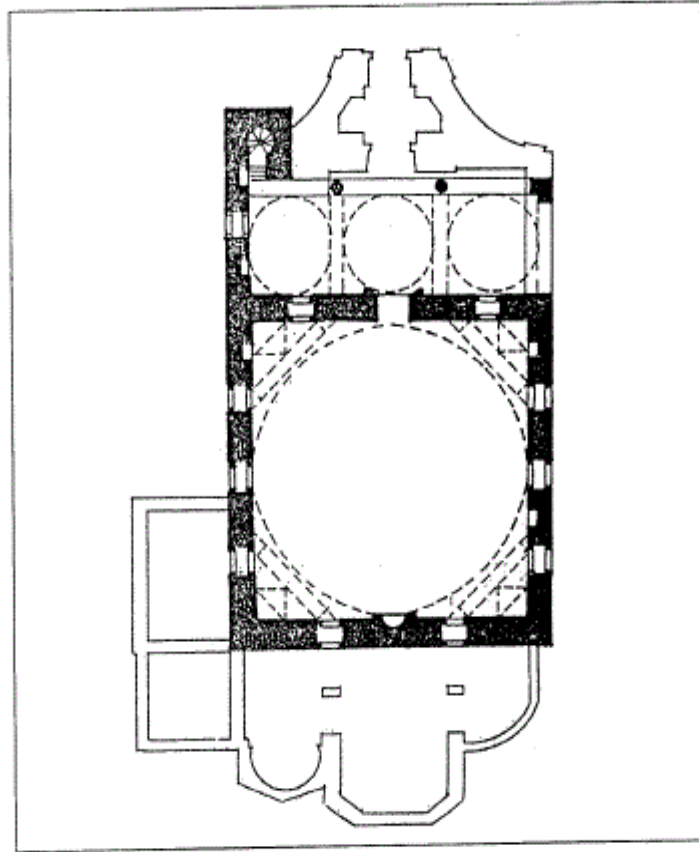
مسقط أفقي لمسجد تاتار (تتر) سنان بك في Cumanovo (عن : كيل) .
